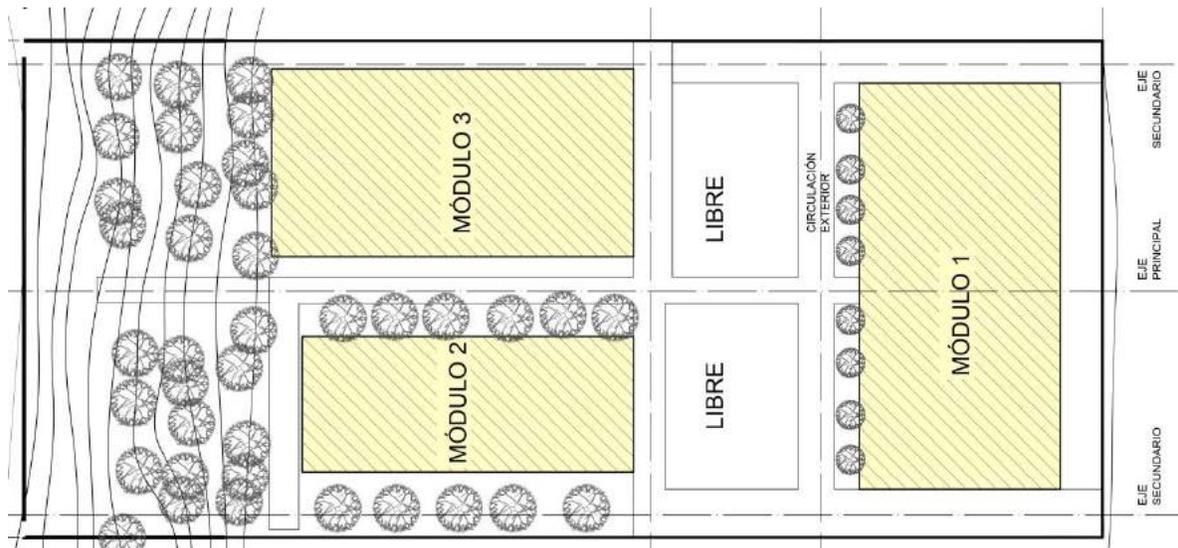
Planta de idea principal. Fuente: Elaboración propia
